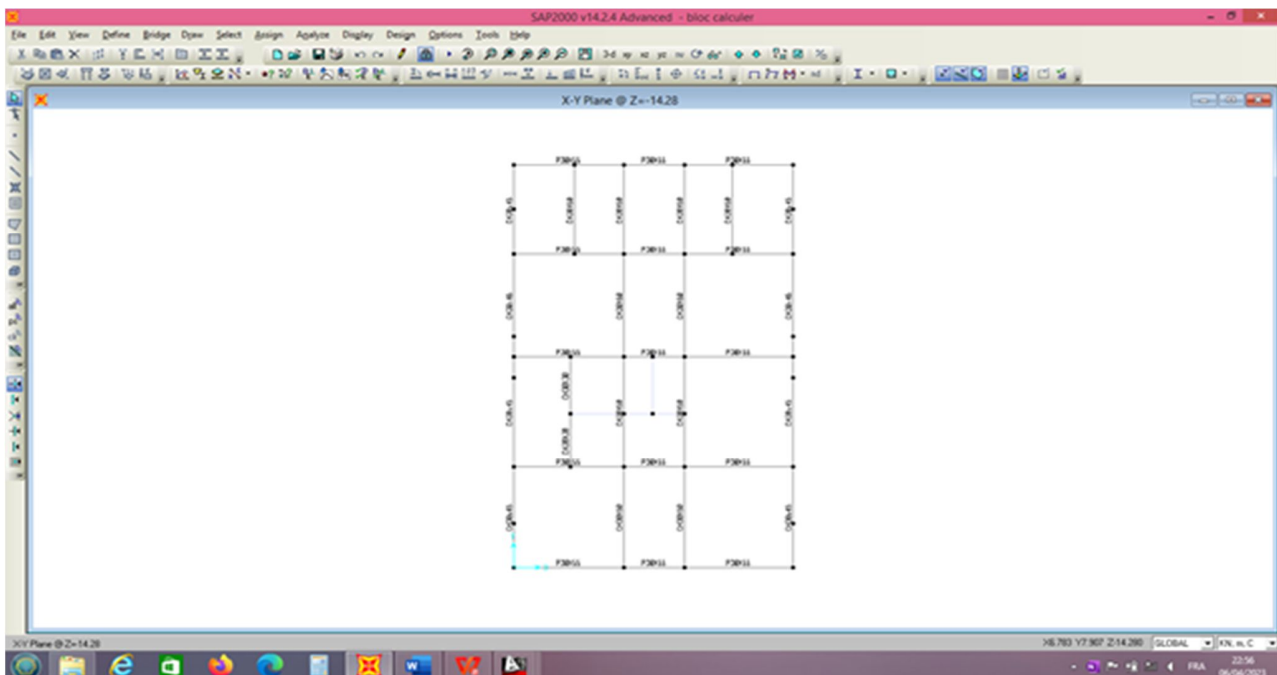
2Pré dimensionnement des Poutres principales et secondaires
